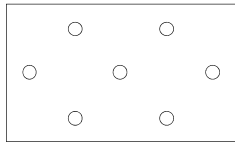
Panneaux PTP-S-035 de dimensions 800 x 625 mm - plans de chevillage en plein et en joint (espacement entre chevilles ≥ 200 mm)
